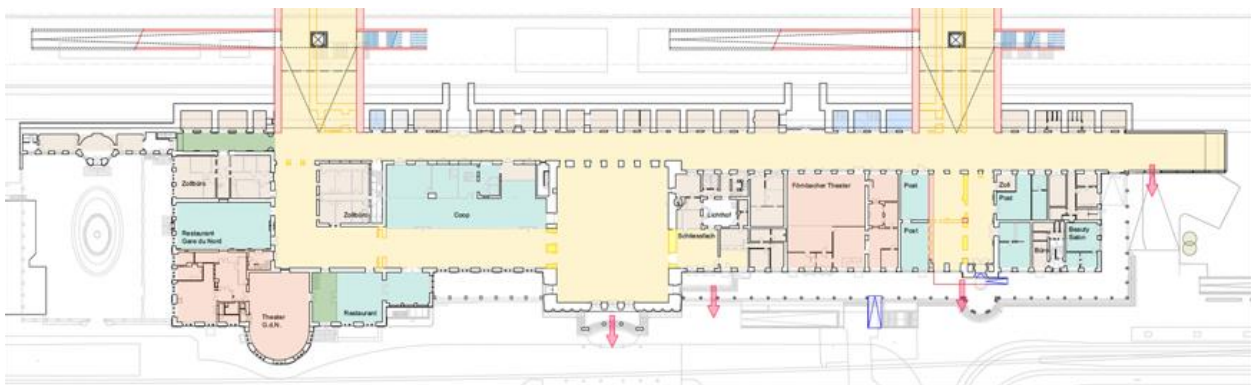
Grundriss Aufnahmegebäude mit Bewegungszone (gelbe Fläche), Abbruch einzelner Elemente (gelb) und geplanten Ausgängen (rote Pfeile)
